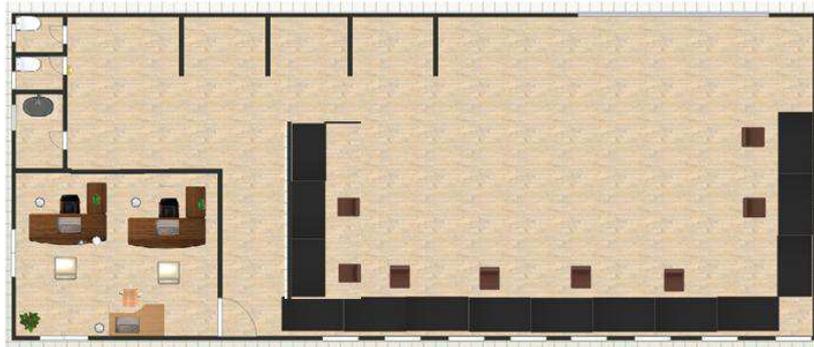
layout do galpão a ser utilizado para a montagem da empresa
